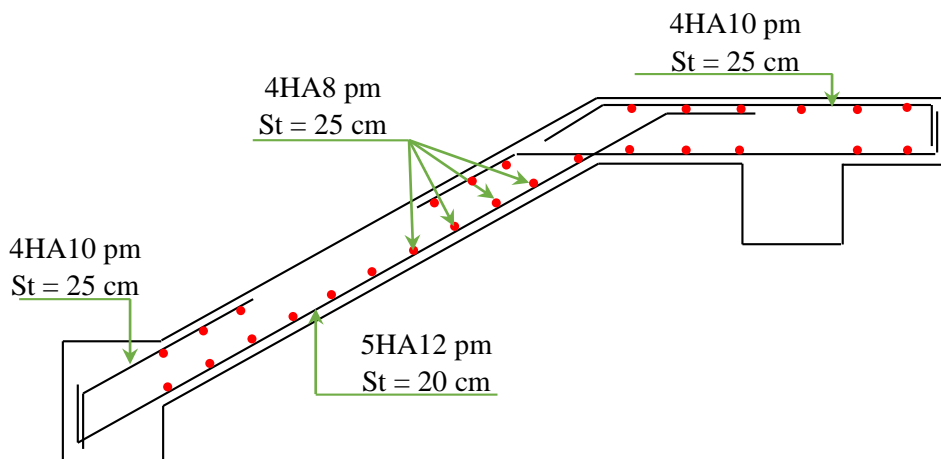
Schéma de ferrailage de l'escalier type (1)
